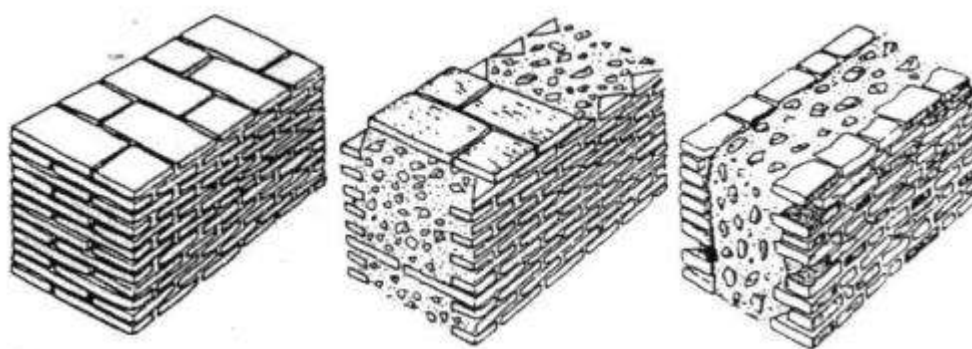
Construcción de muro de mampostería antiguo, (Medina Espinosa, 2001).
